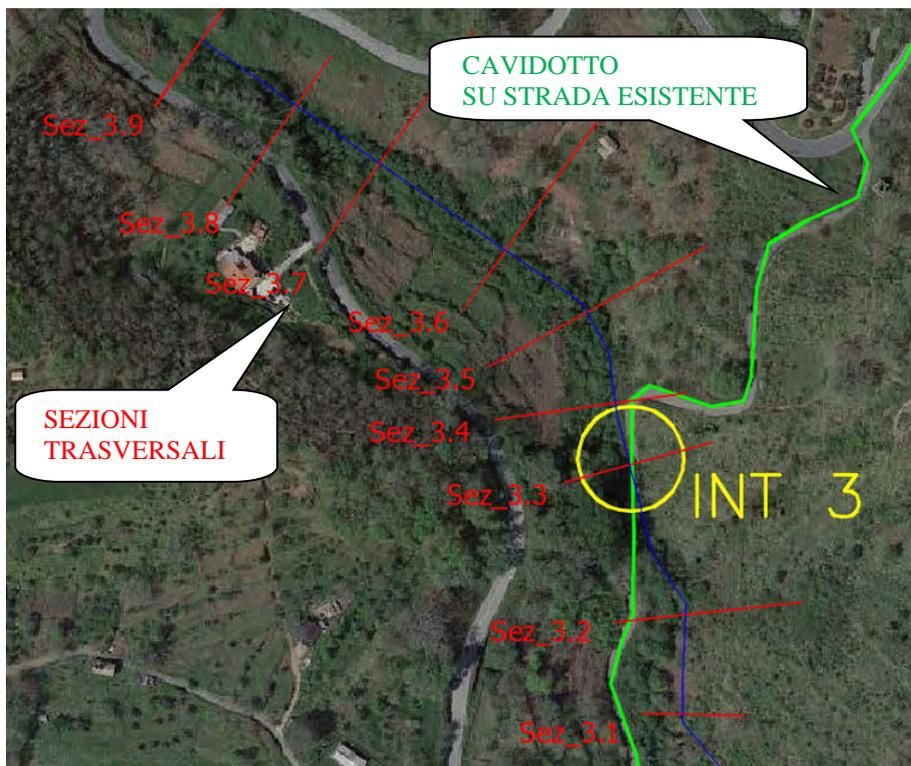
Planimetria con indicazione delle sezioni in dwg su base ortofoto.
